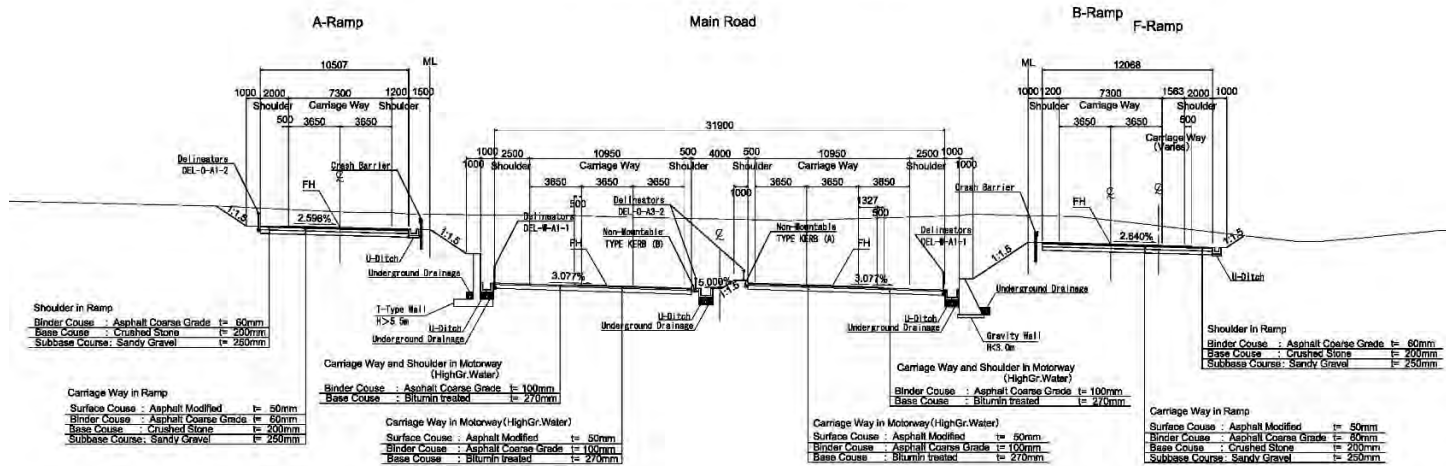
Motorway-Afiao Road 標準横断面図(2)
